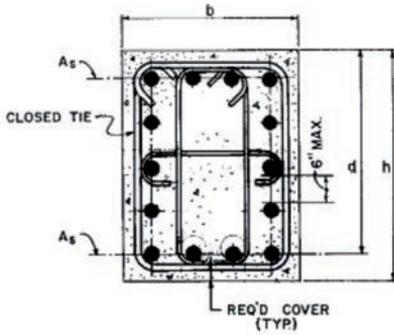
Detalle de pilar de hormigón armado, resistente a solicitaciones y esfuerzos derivados de explosión.
